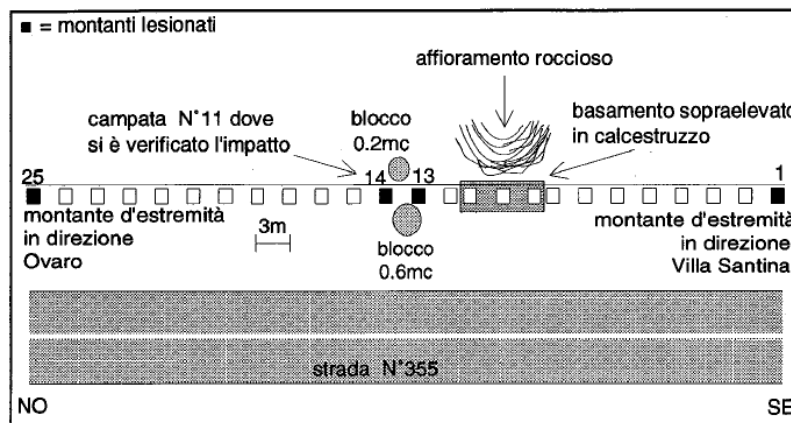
Schema planimetrico del caso di Villa Santina. [54]
